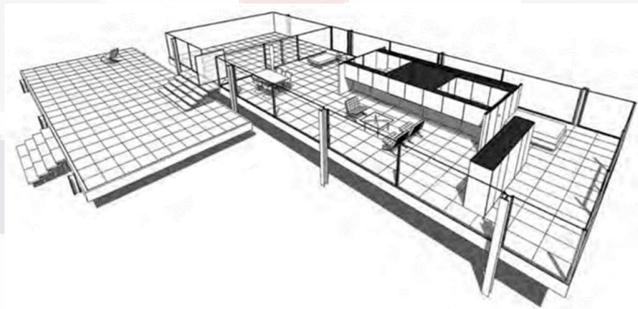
Corte Isométrico de casa Fransworth donde se muestra la función externa de la estructura en una planta libre solamente dividida por muros mueble.
